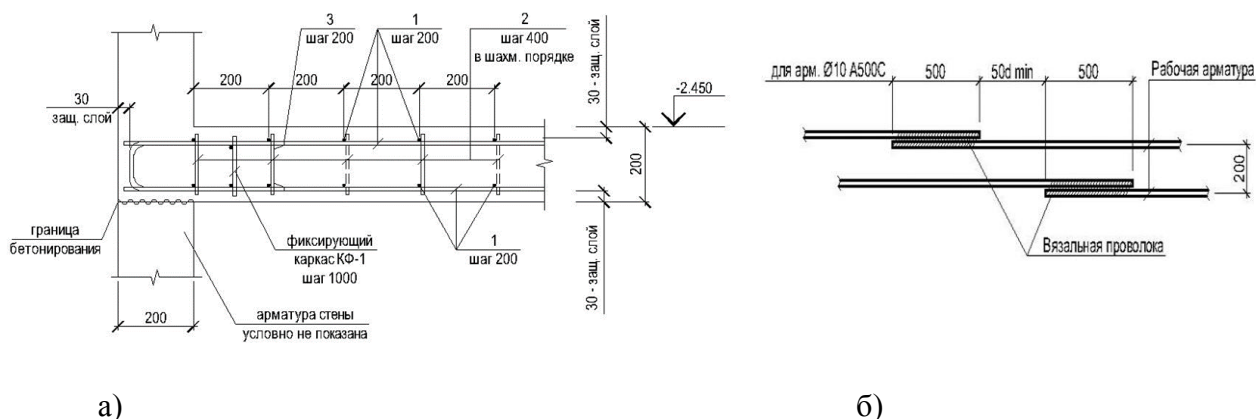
Армирование перекрытий подвала: а) деталь основного армирования; б) соединения стержней рабочей арматуры внахлёт (взято из проекта № 2287-01/00,01,02, МТП АПМ Веснина)
